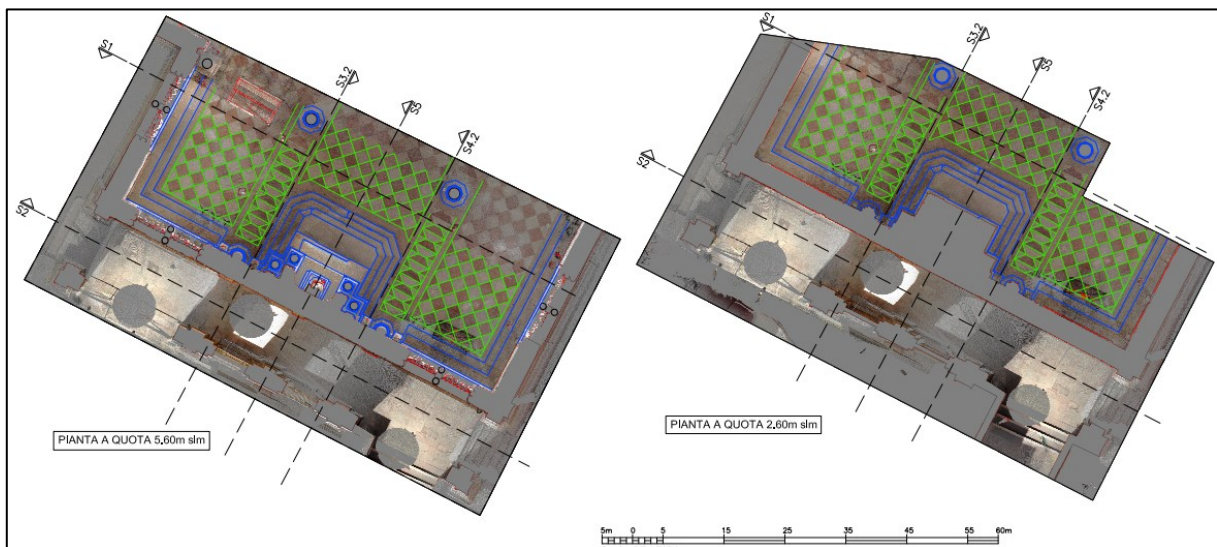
Pianta parete sud – Sezioni orizzontali con sovrapposizione delle orto-proiezioni del modello tridimensionale
